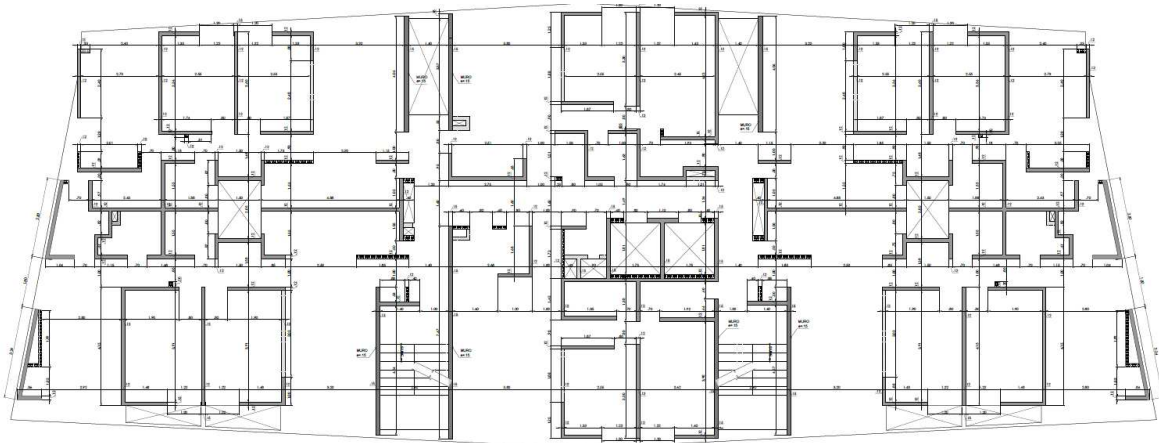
Planta Estructural Pisos 7 a 12, muros $e=0.12$ m. Fuente: Elaboración propia.
